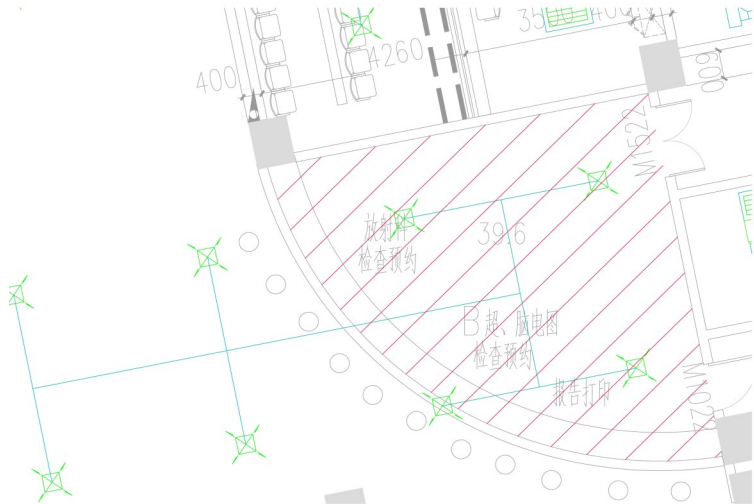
门诊大厅检查预约、报告打印处空调风管平面图
